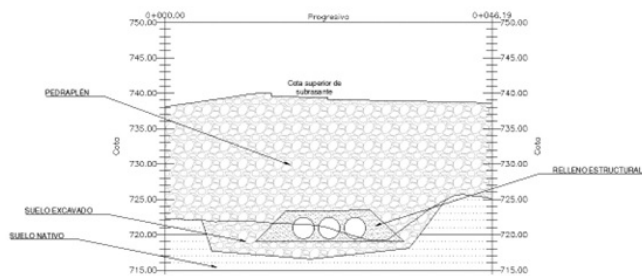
Geometría de la alcantarilla que atraviesa el proyecto carretero Autovía Alternativa 8N
